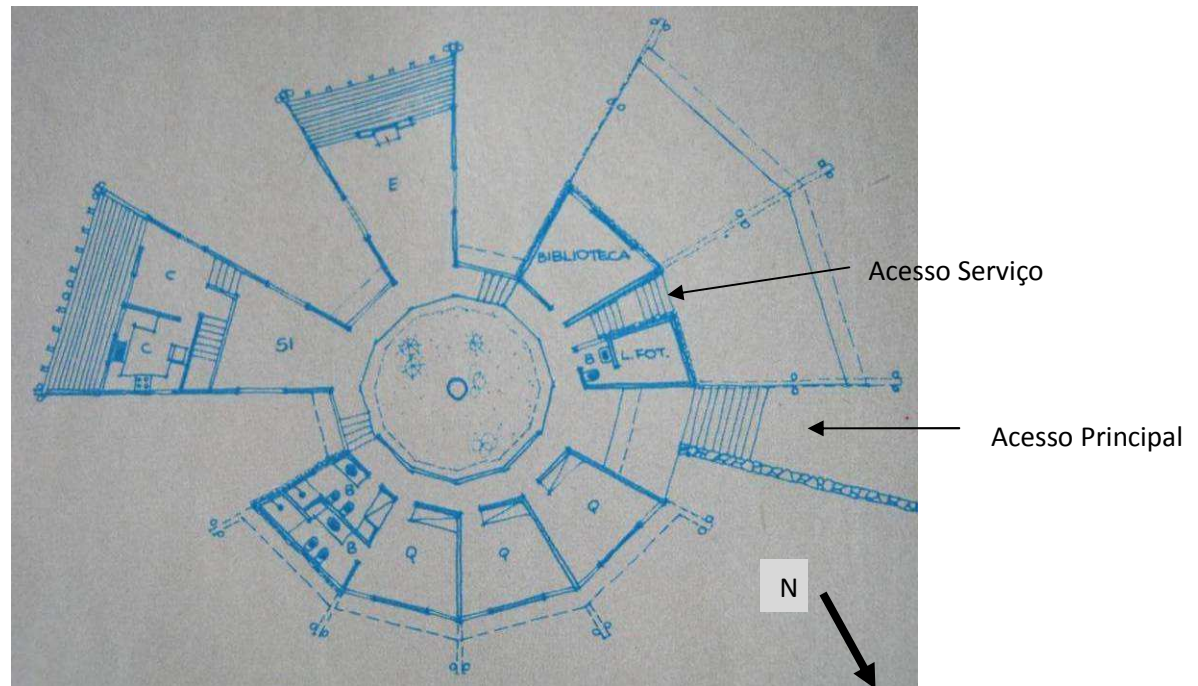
Residência Oswaldo Navarro Alves*: Planta do pavimento térreo.
